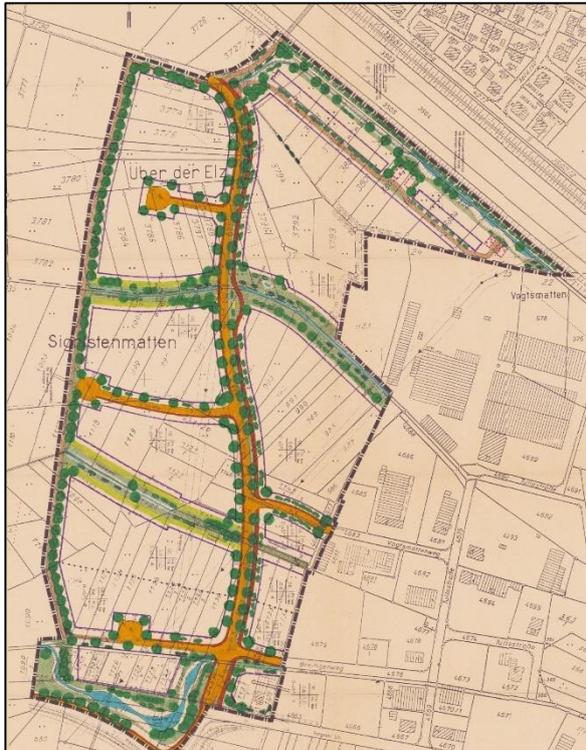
Bebauungsplan „Breitigen II“ (1998);
